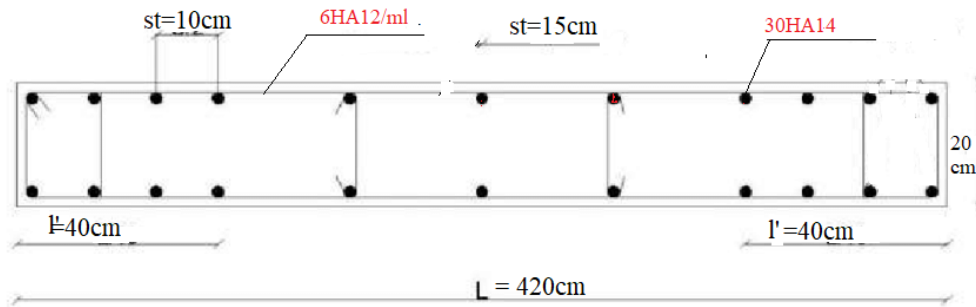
Coupe longitudinale du ferrailage des voiles (RDC + 1er + 2ème étage)
